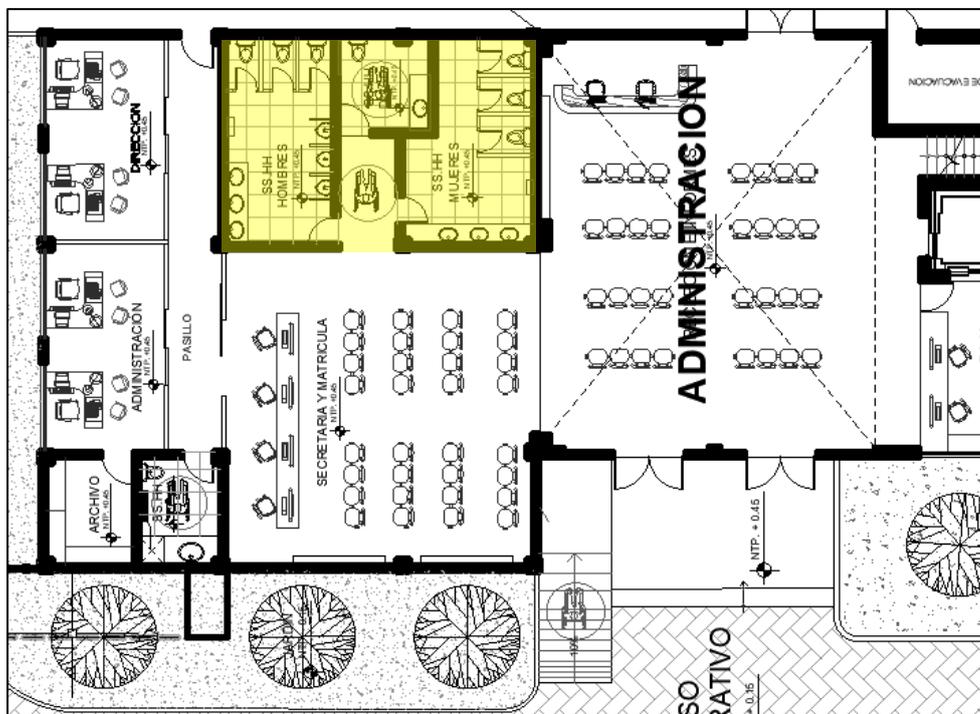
Planta primer nivel del proyecto-Administración. FUENTE: Elaboración propia.
